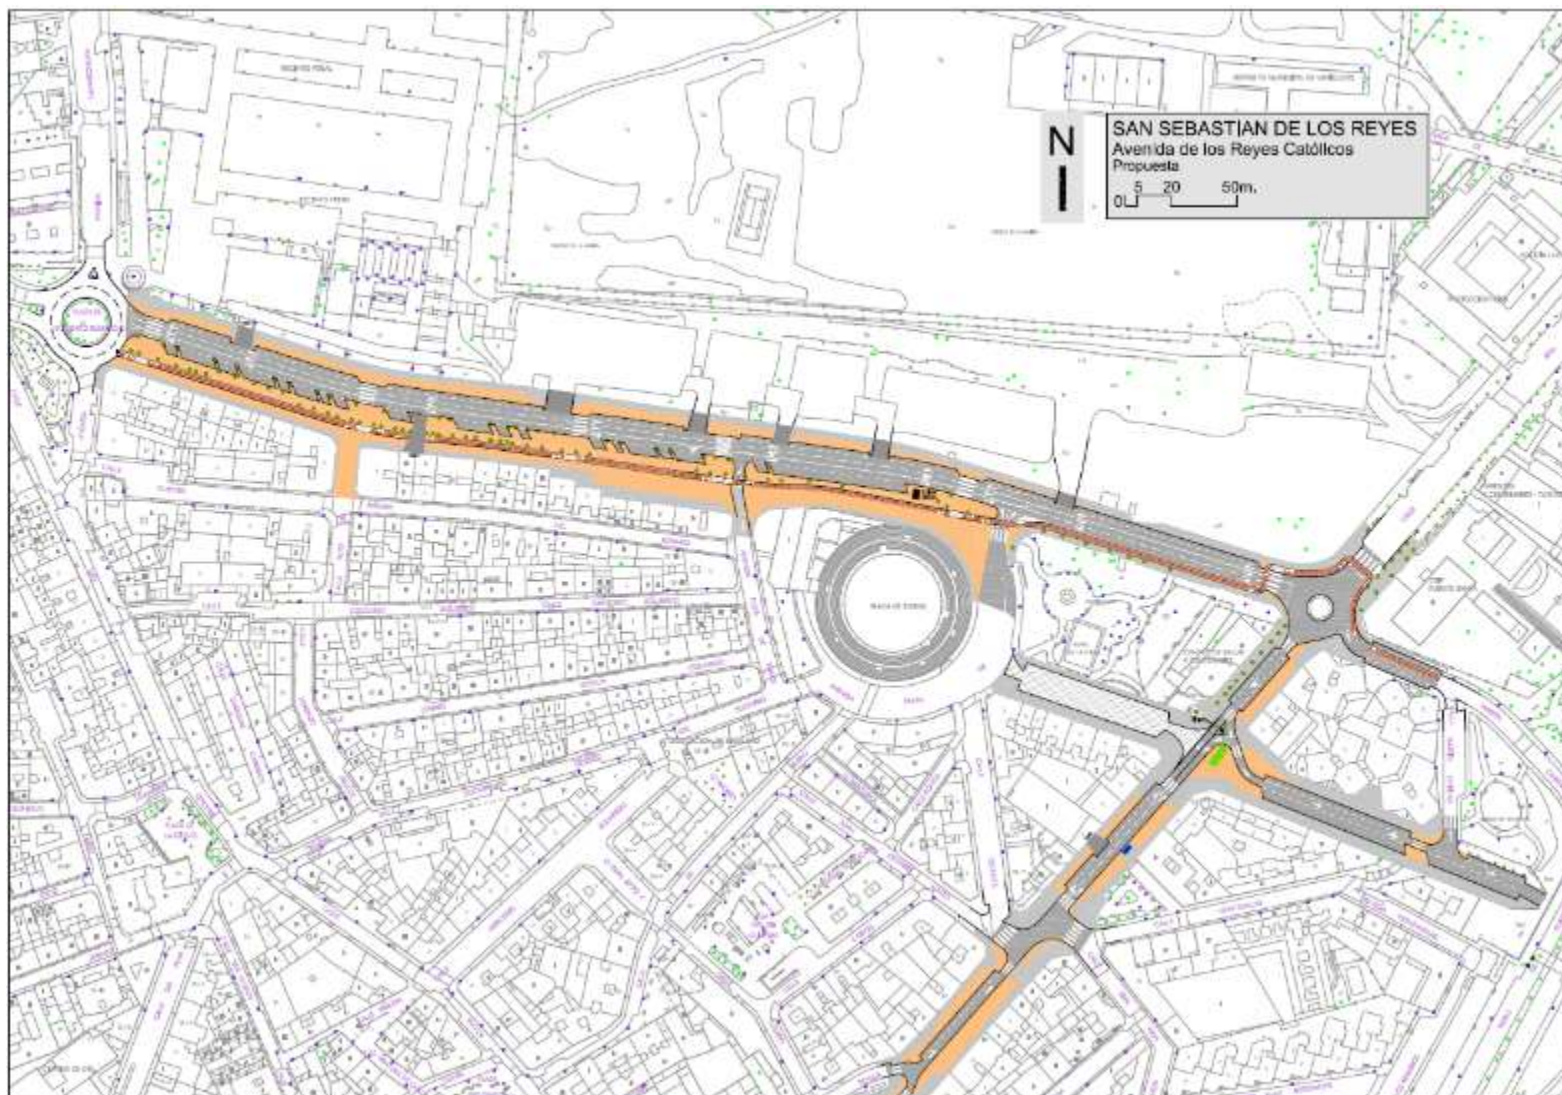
Planta propuesta Alternativa 1 para Avenida Reyes Católicos. Fuente: DOYMO.
